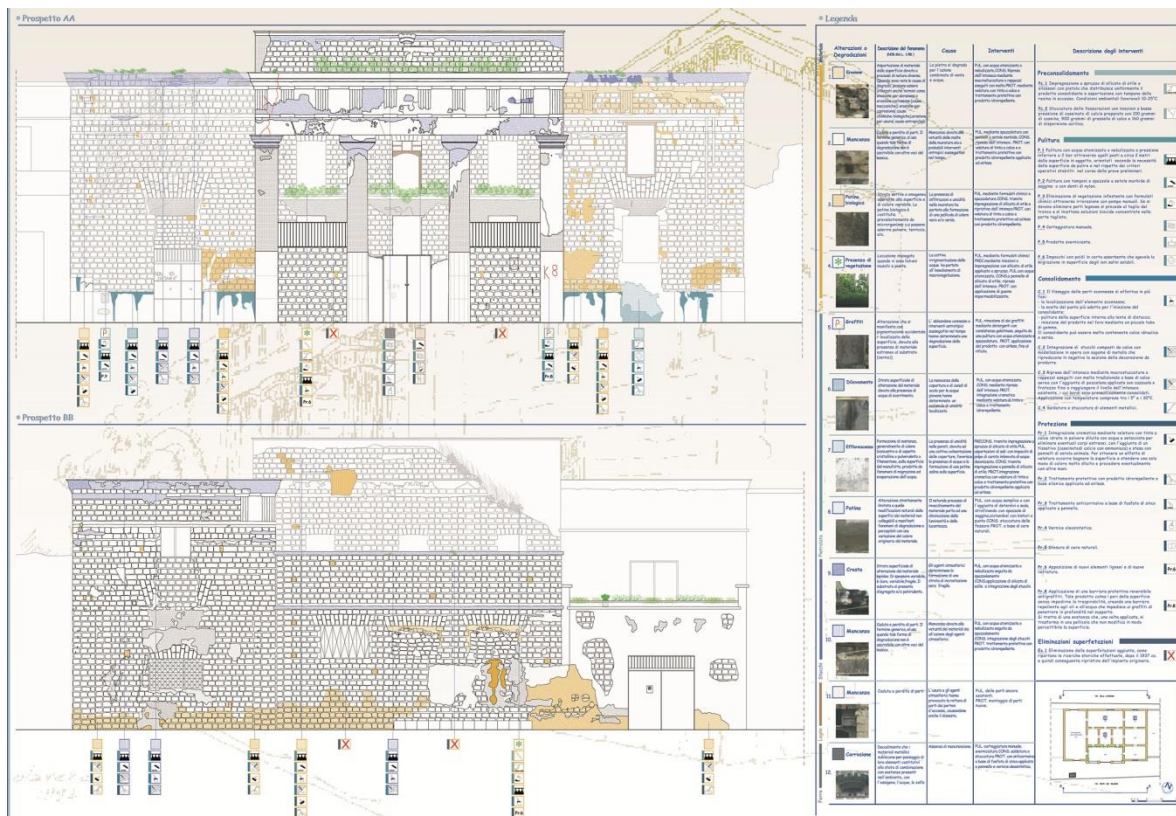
Dogana al Ponte della Maddalena. Rilievo del degrado e progetto di conservazione delle facciate.
